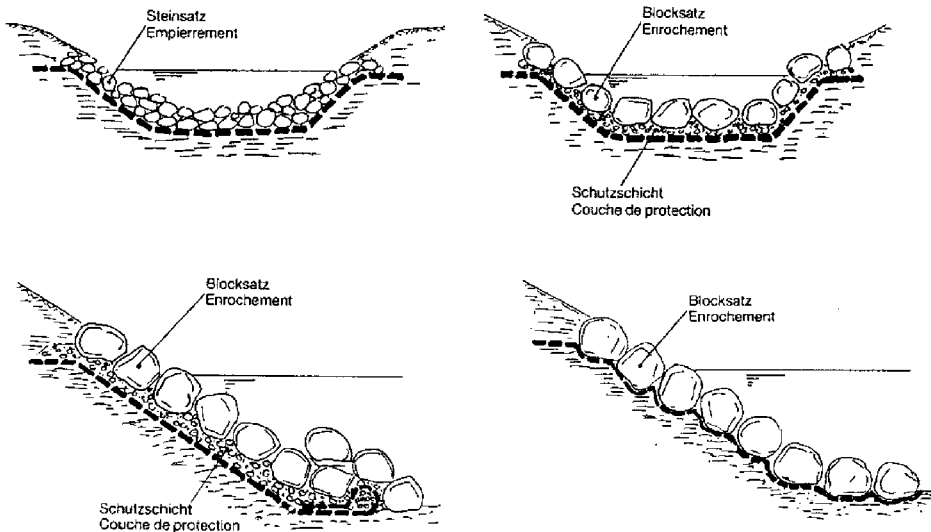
Einbau von Geotextilien zur Uferbefestigung [NN, 2003]
